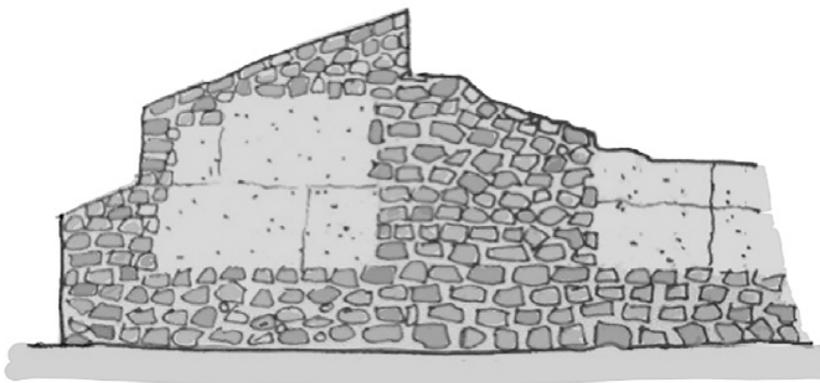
Muro con tapia y piedra careada. Croquis: M. Franco y D. Romero, 2020.
